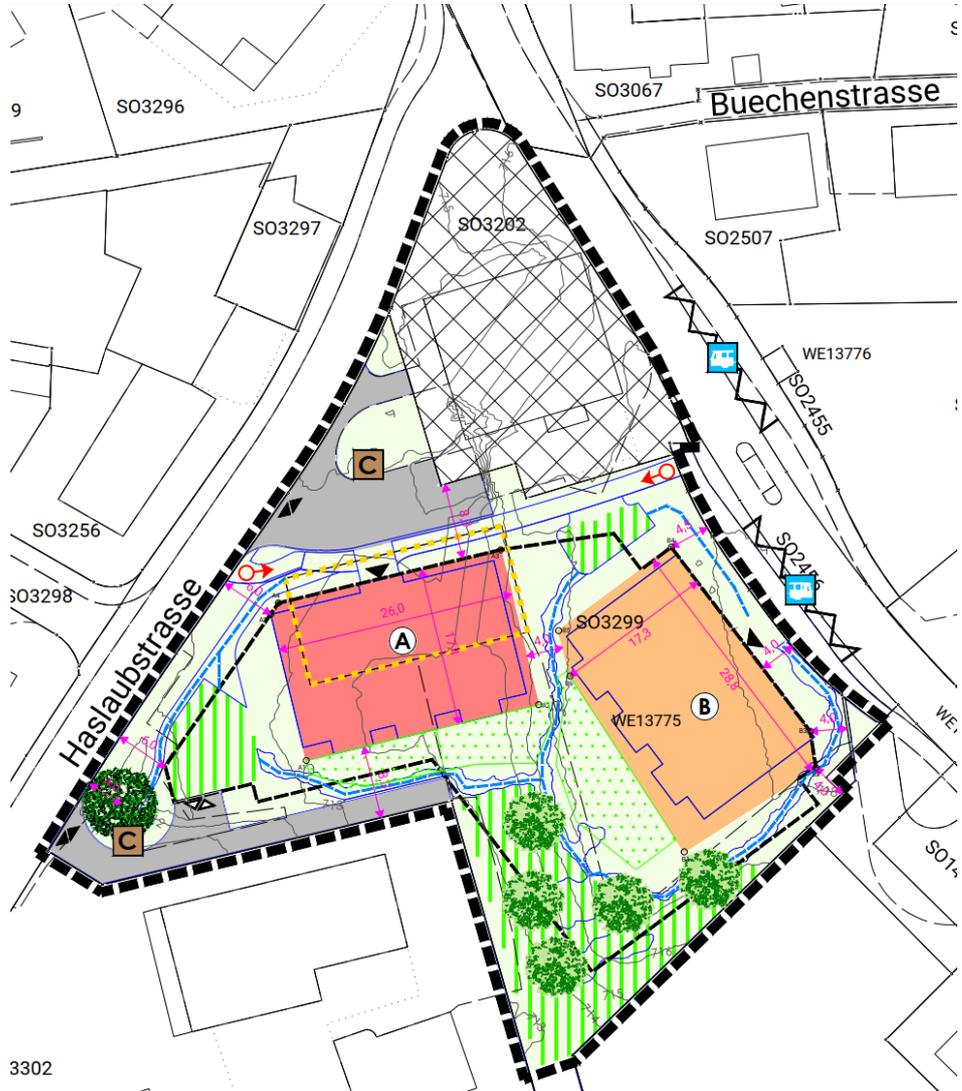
Situationsplan GP «Vorder Schönenberg II» (Darstellung R+K)
